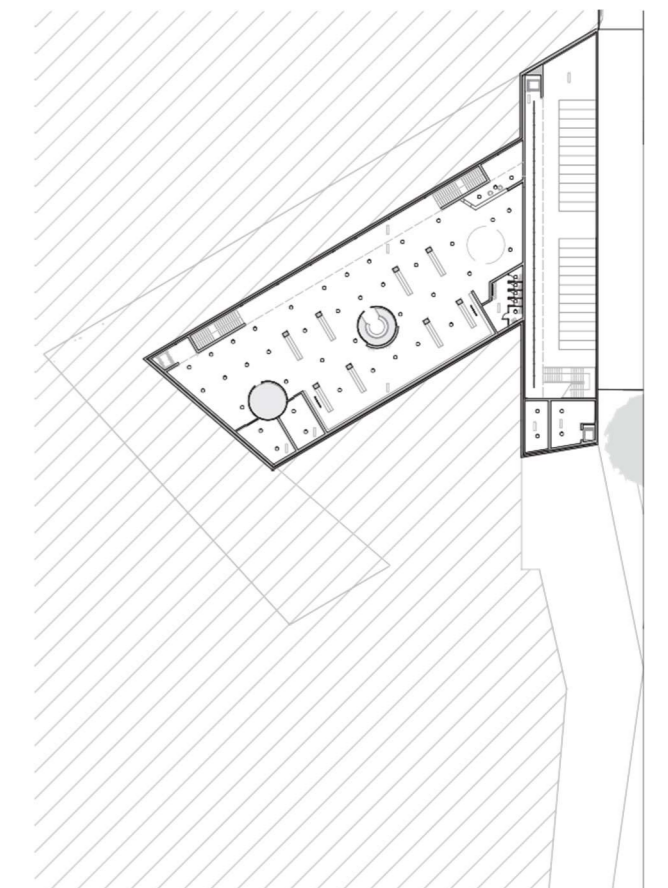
Desenho do autor, Planta de tetos do piso -1
